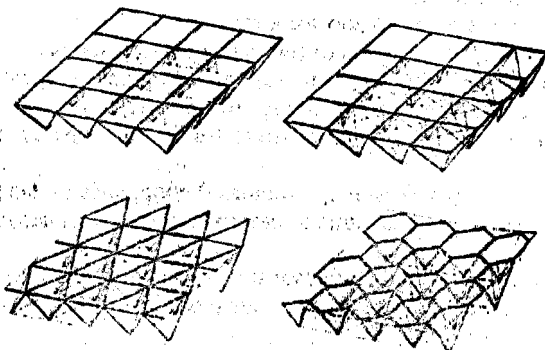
Схемы перекрёстно-стержневых конструкций из решётчатых пирамид: а, б – из пирамид с квадратным основанием (пентаэдров); в – из пирамид с треугольным основанием (тетраэдров); г – из пирамид с шестиугольным основанием (гексаэдров)
